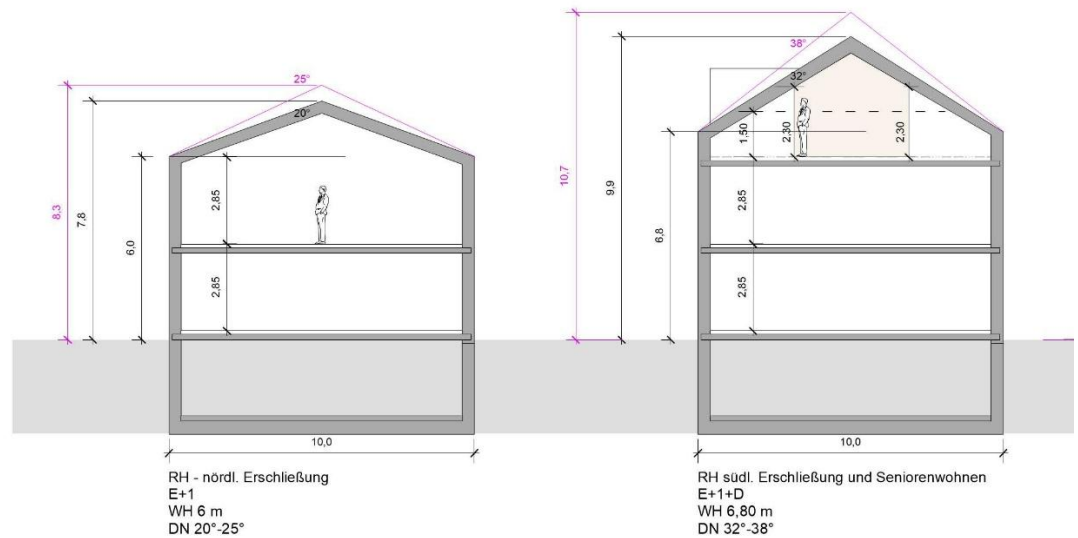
Gebäudetypen Reihenhäuser im Plangebiet – Städtebaulicher Entwurf, Stand 09.12.2025
